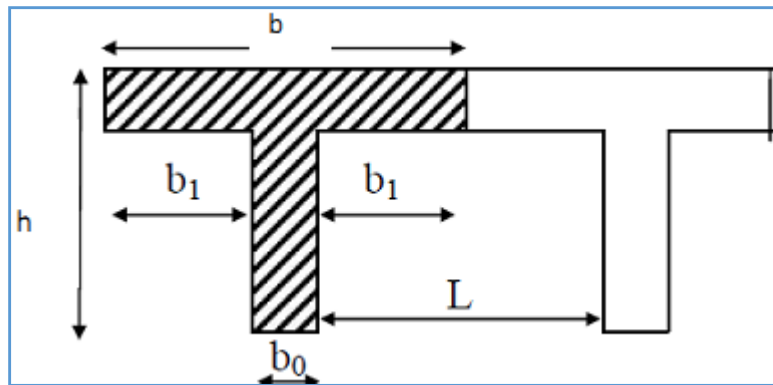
Section de la poutrelle après coulage de la dalle de compression
